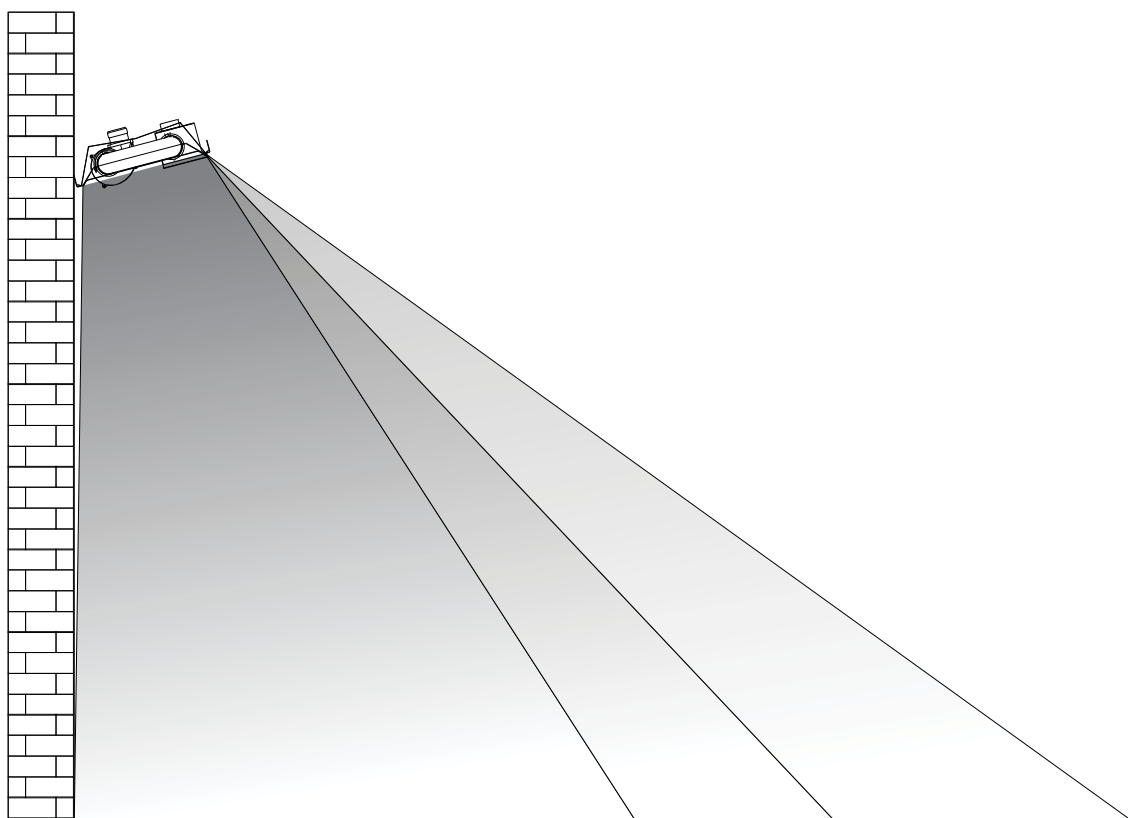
Монтаж на стене с помощью кронштейна типа "макси"
